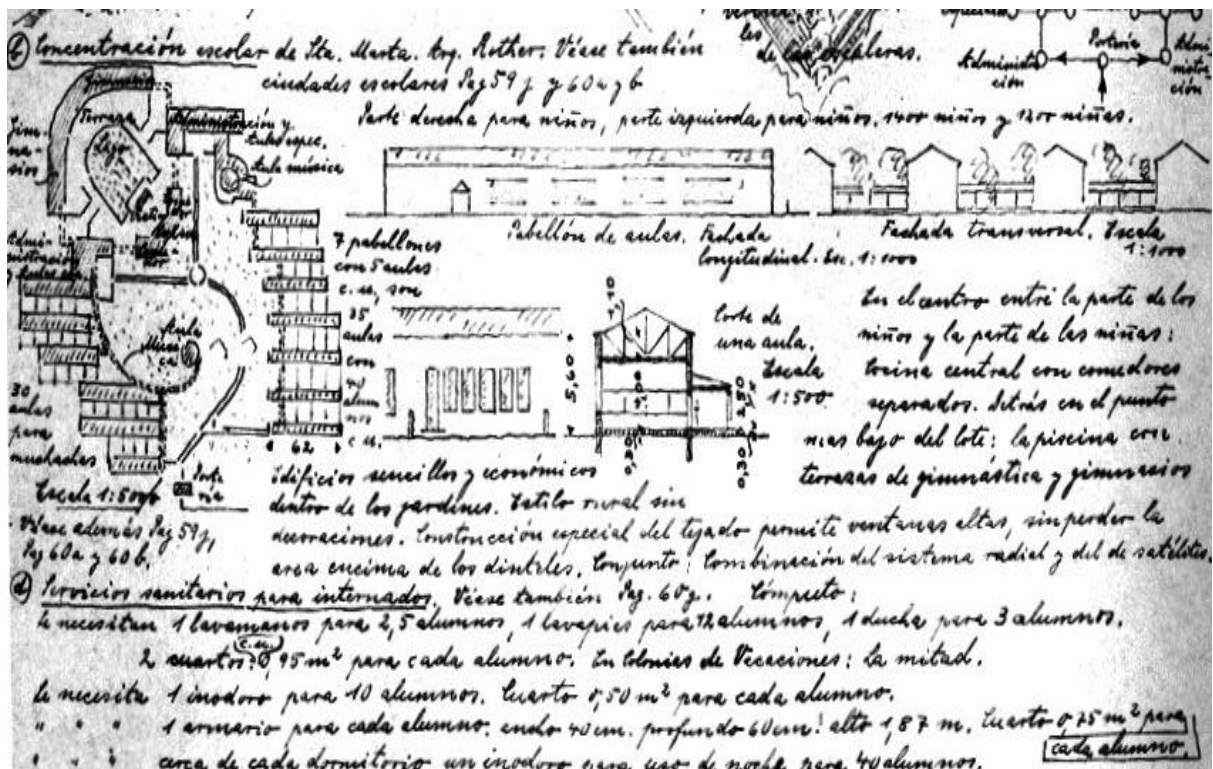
Ausschnitt aus der 64. Vorlesung mit Grundriss, Ansichten und Schnitte der Schulstadt von Santa Marta.
